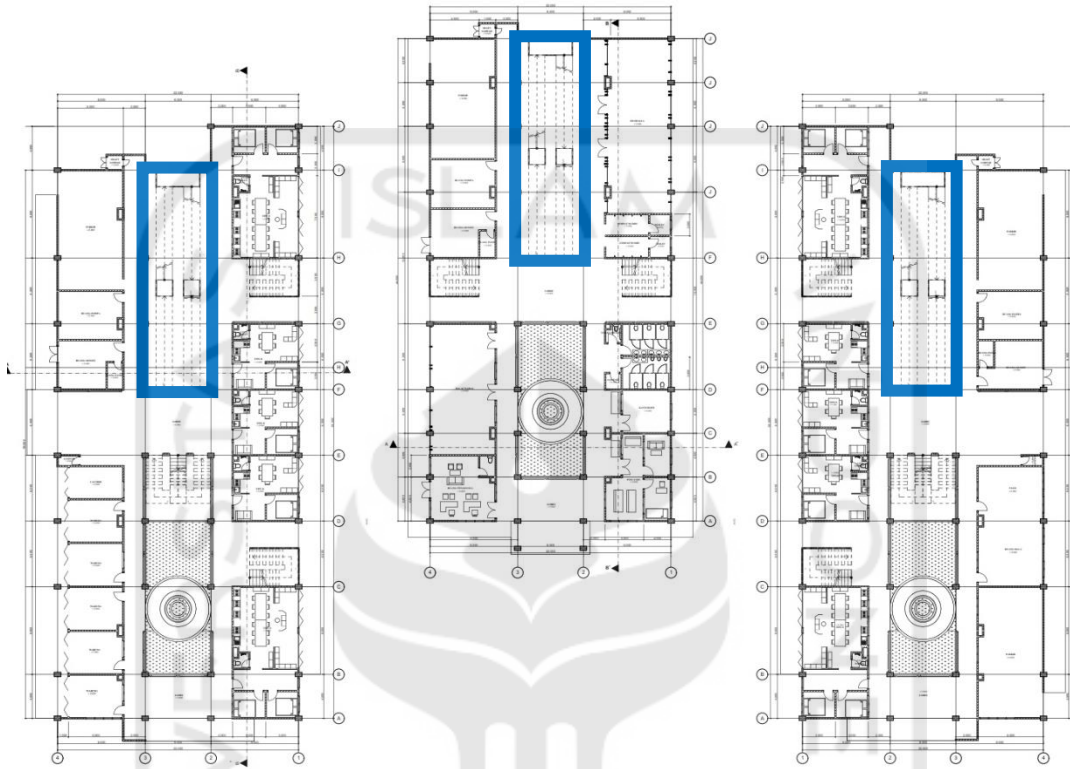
Ramp Masuk Bangunan Sebagai Barrier Free Design
